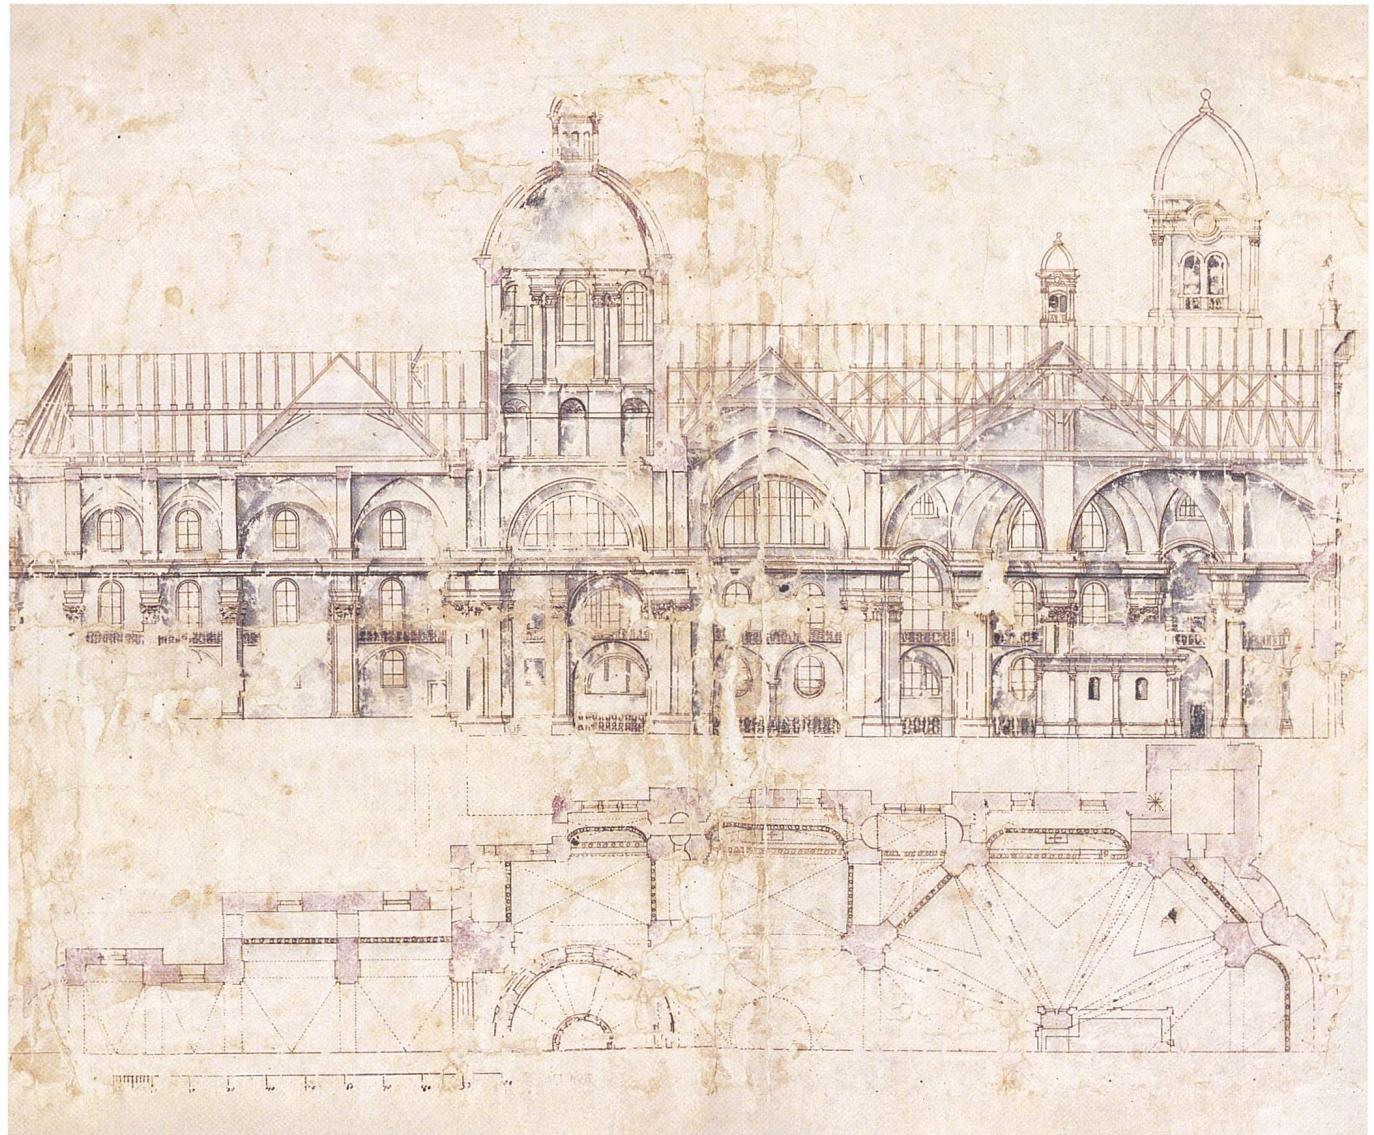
Der ebenfalls in das Jahr 1717 zu datierende letzte erhaltene Plan von Caspar Moosbrugger zeigt den halben Grundriss und den Längsschnitt der projektierten Klosterkirche Einsiedeln. Er entspricht noch nicht dem ausgeführten Gebäude, enthält nun aber alle relevanten Projektideen. KAE, 2.0501.0001.
